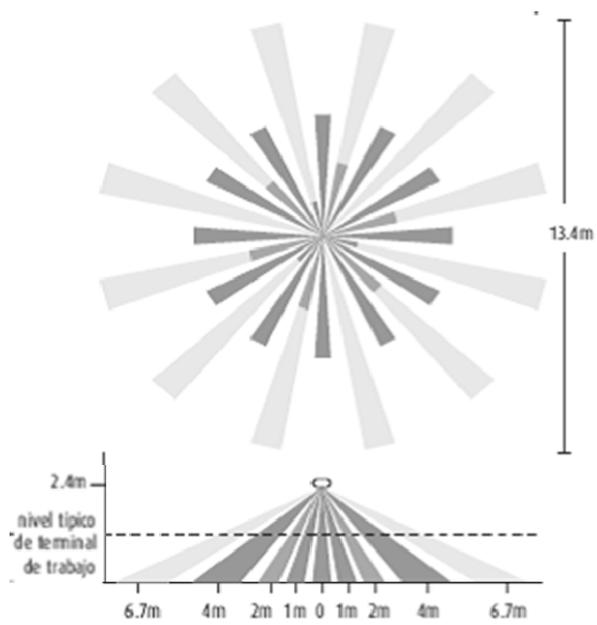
Cobertura sensor CI-200. a) Planta. b) Horizontal
